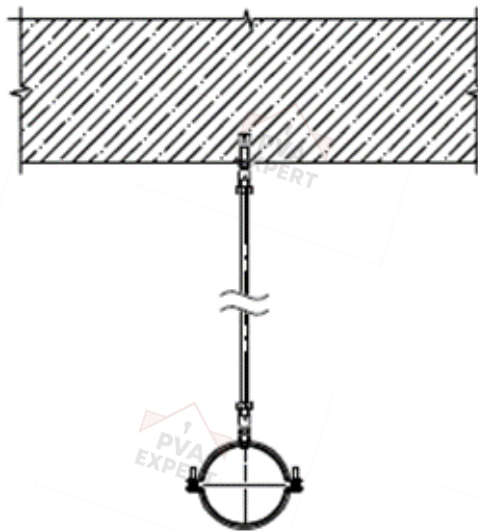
Узел крепления трубы к перекрытию с установкой маятниковых подвесов (маятниковая опора)
